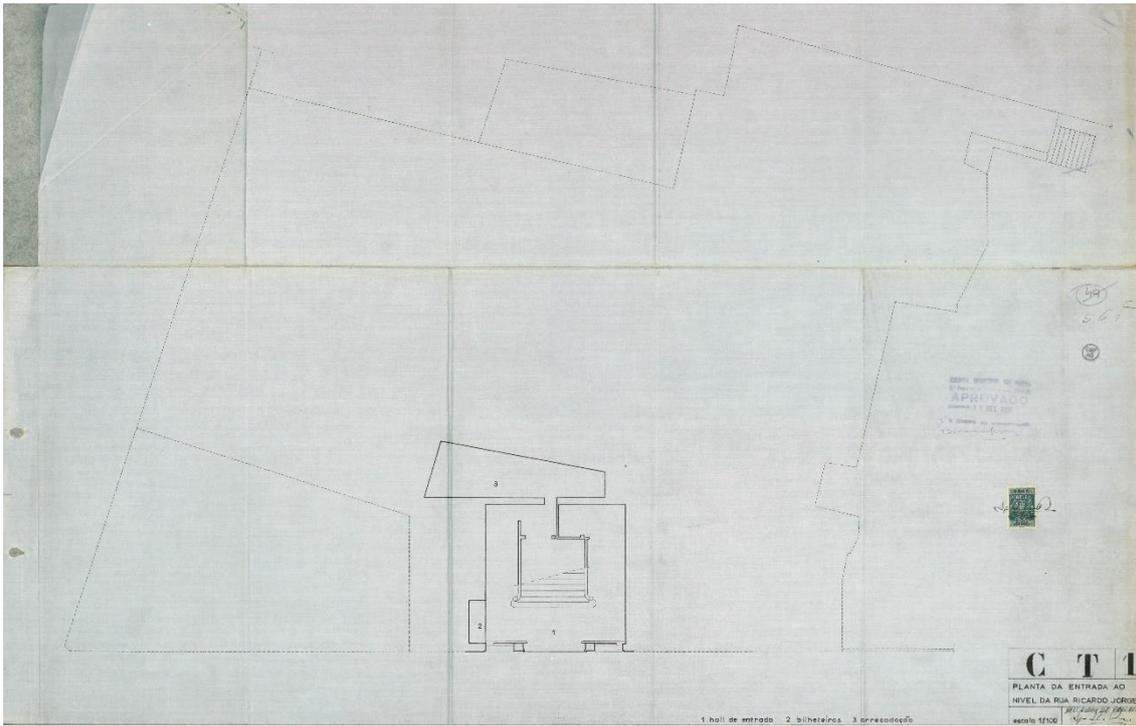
Planta da entrada ao nível da Rua Ricardo Jorge (hall de entrada, bilheteiras e arrecadação)
